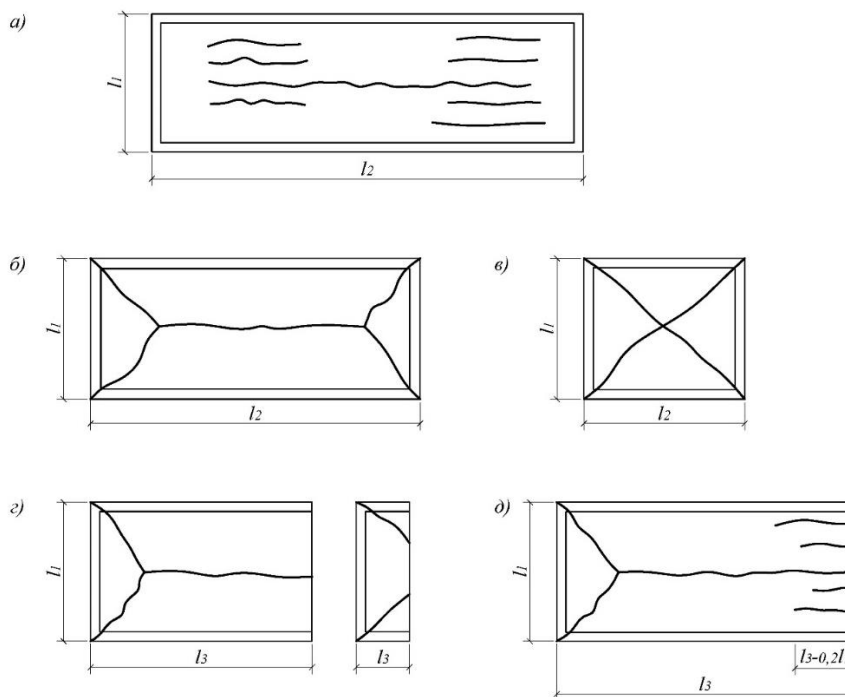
Трещины по нижней поверхности плит перекрытия и покрытия (в растянутой зоне): а – работающих по балочной схеме; б, в - опертых по контуру; г – опертых по трем сторонам, при $l_3/l_1 \leq 1,5$; г – опертых по трем сторонам, при $l_3/l_1 > 1,5$.
